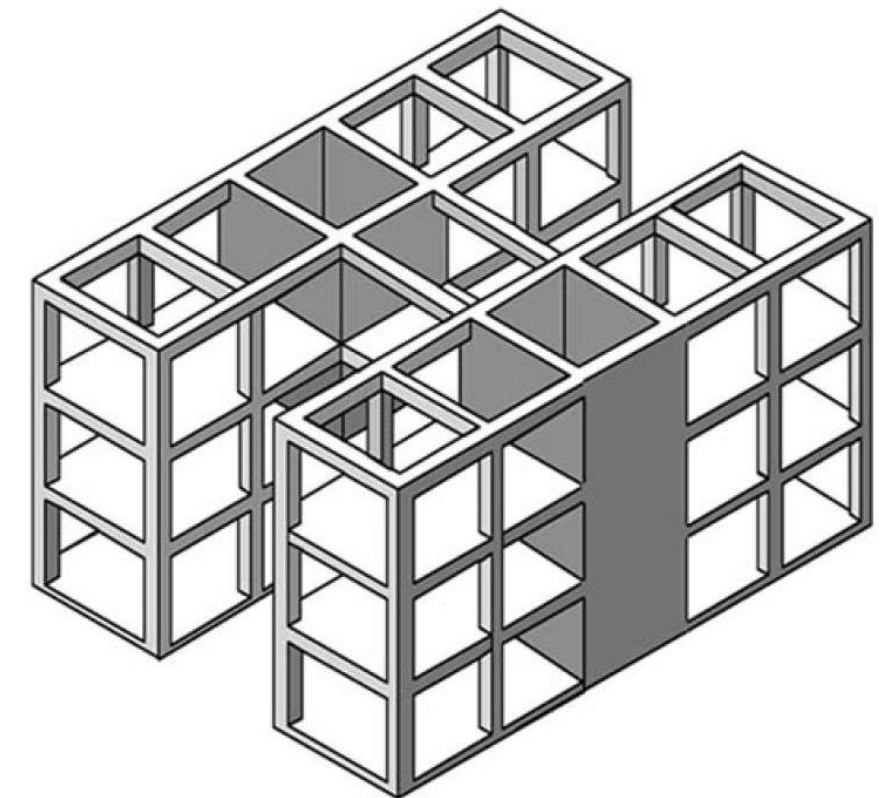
Sistema Estructural Aporticado de estructura metálica.
